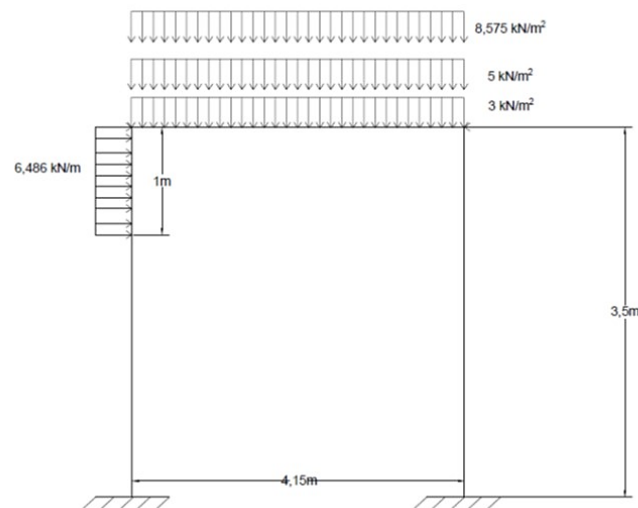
Pórtico para el cálculo de las fuerzas actuantes del muro.
